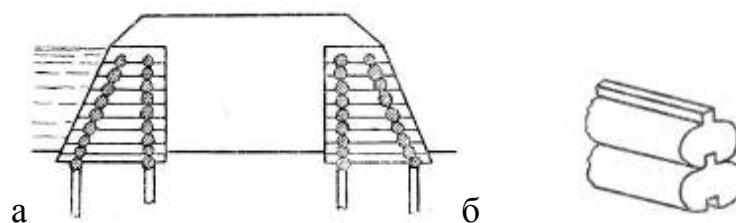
Плотина с ряжами по всей её длине с обеих сторон: а – поперечное сечение плотины; б – рубка ряжей на шпунт
